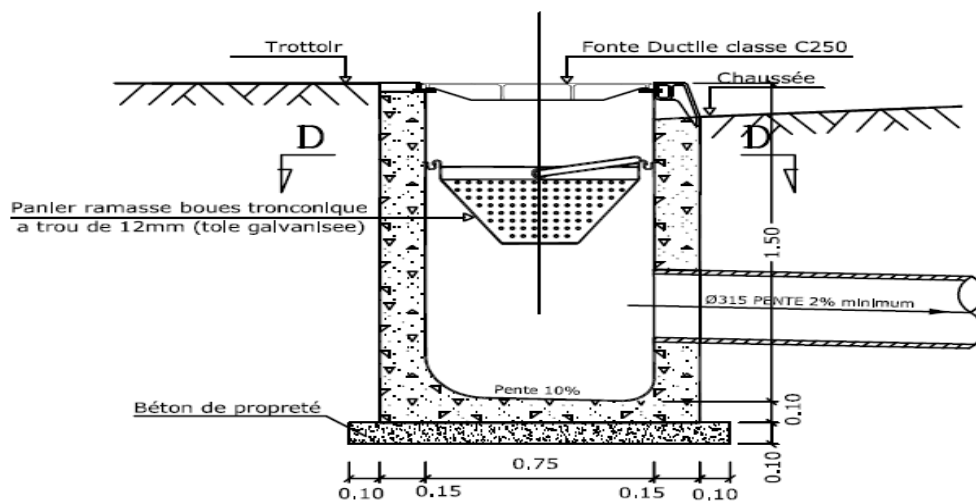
Schéma descriptif d'une bouche d'égout à avaloir (coupe longitudinale) .
